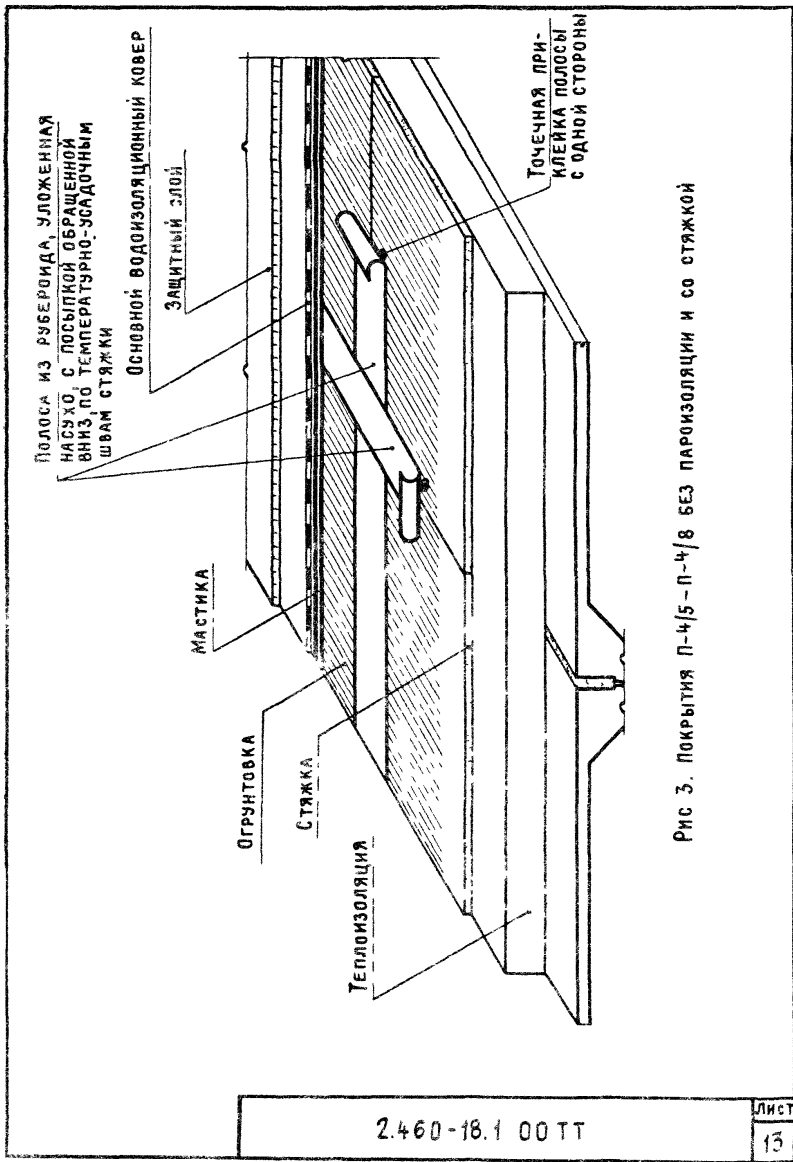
Покрытие П-4/5-П-4/8 без пароизоляции и со стяжкой
